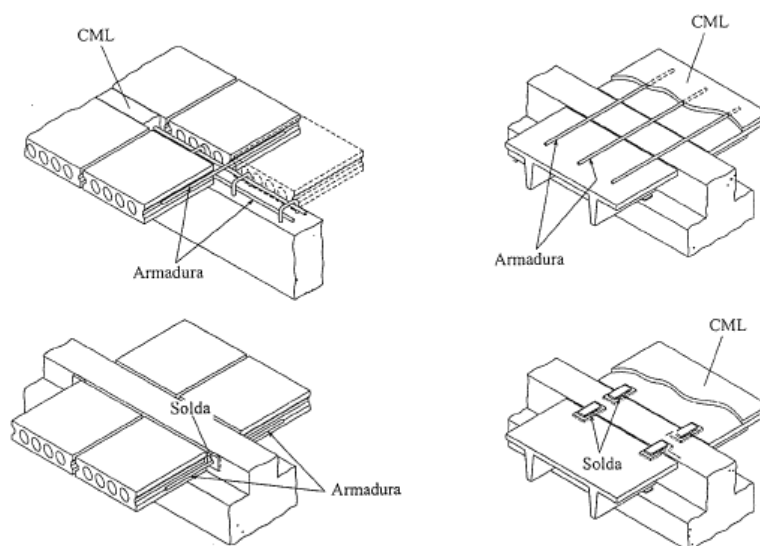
Ligações laje-laje sobre a viga [6]
